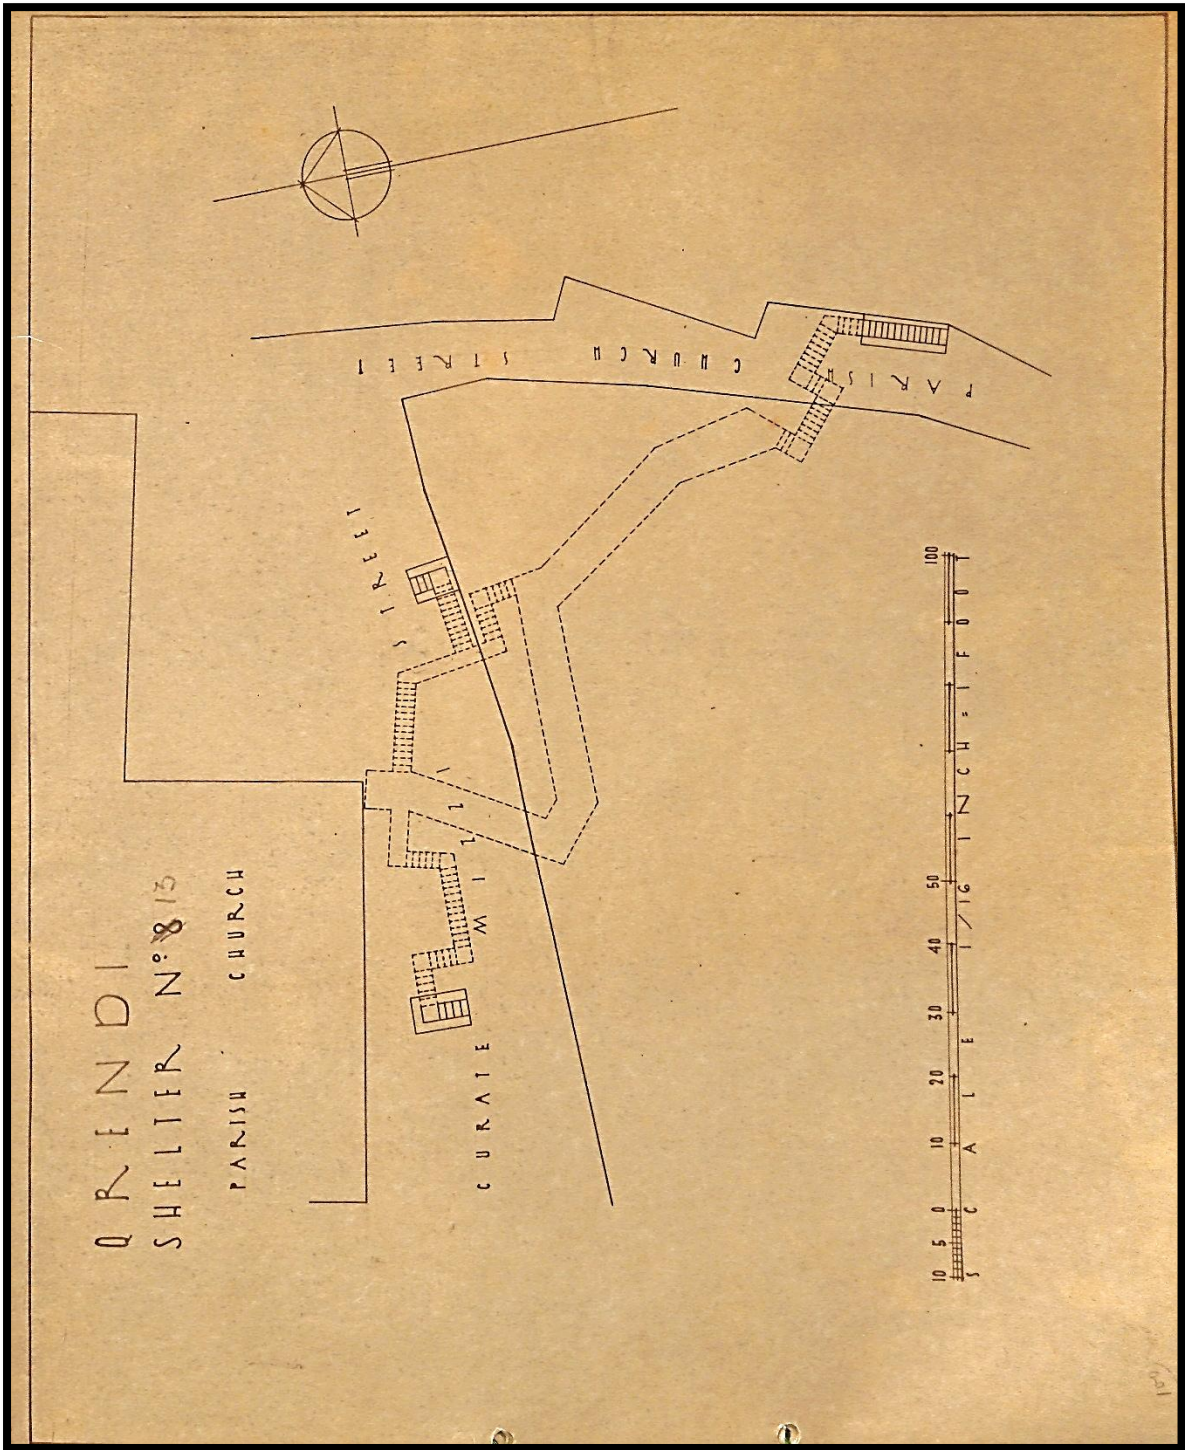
Planta do Abrigo nº13 "Curate Mizzi Street – Parish Church Street."
